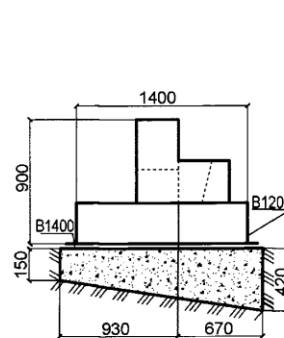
Блоковий ступінчастий фундамент із бетонною підшовою.
